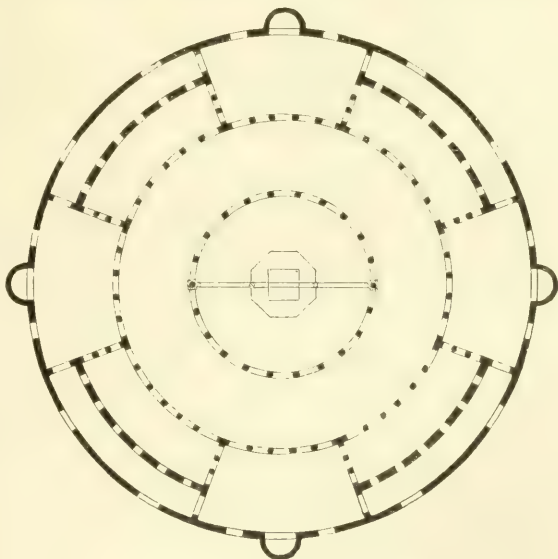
Grundriss von S. Stefano rotondo zu Rom.
